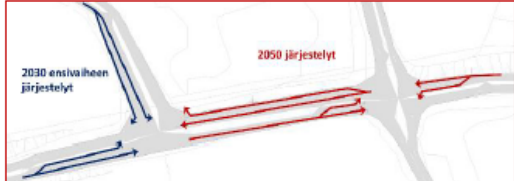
Toimenpidetarpeet mt 130 ja 292 liittymän rampissa, mt 130.
